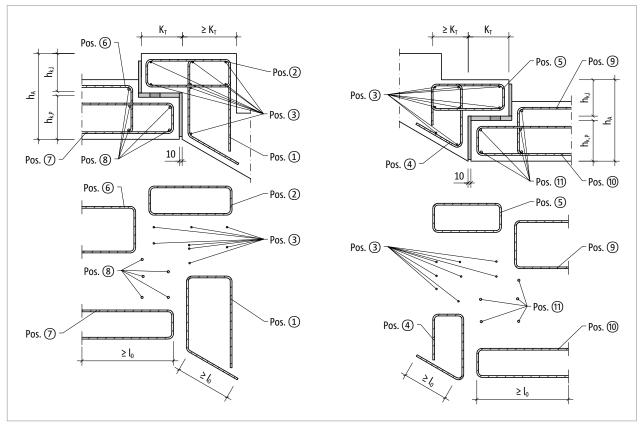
Schöck Tronsole® Typ BZ: Bauseitige Bewehrung bei Konsolanschluss
